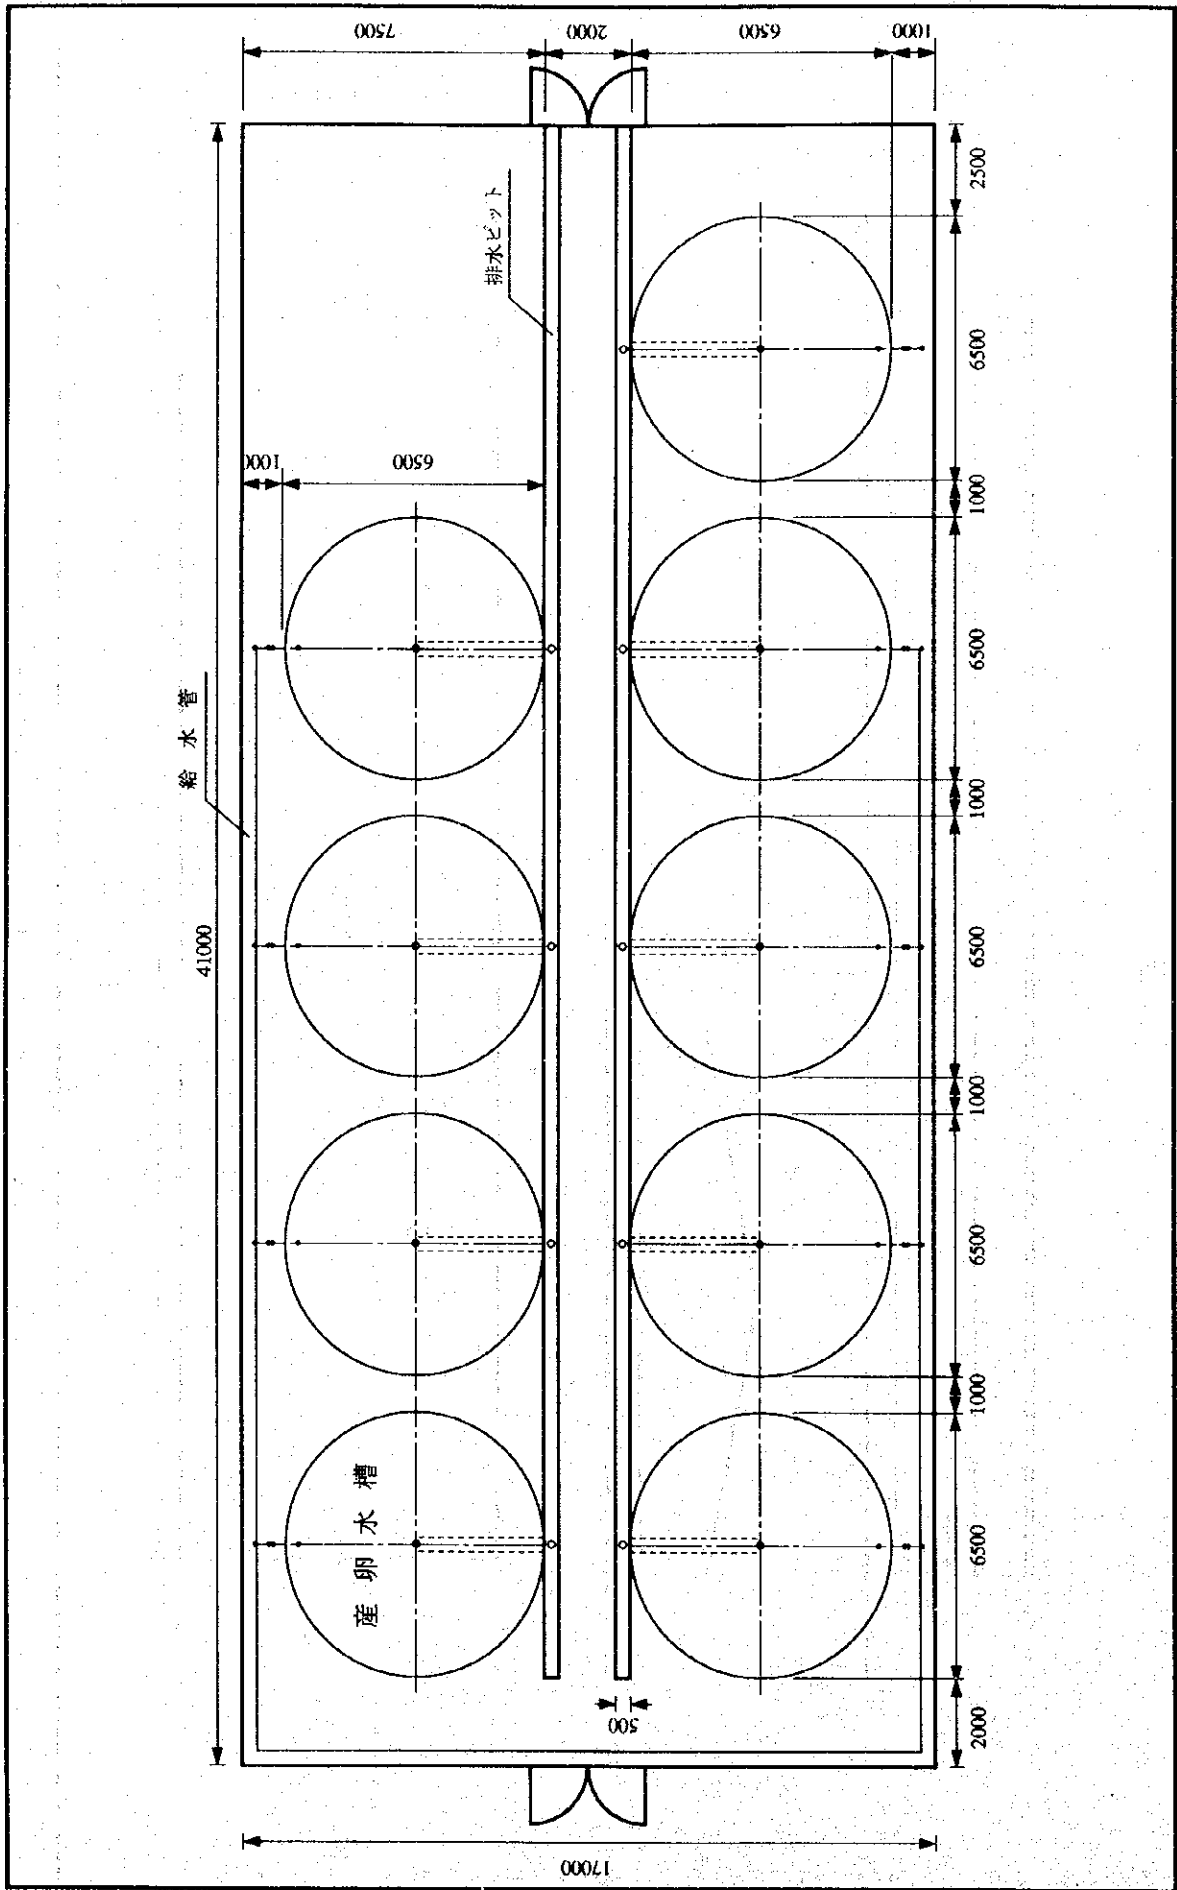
種苗センター産卵用温室水槽配置平面図
